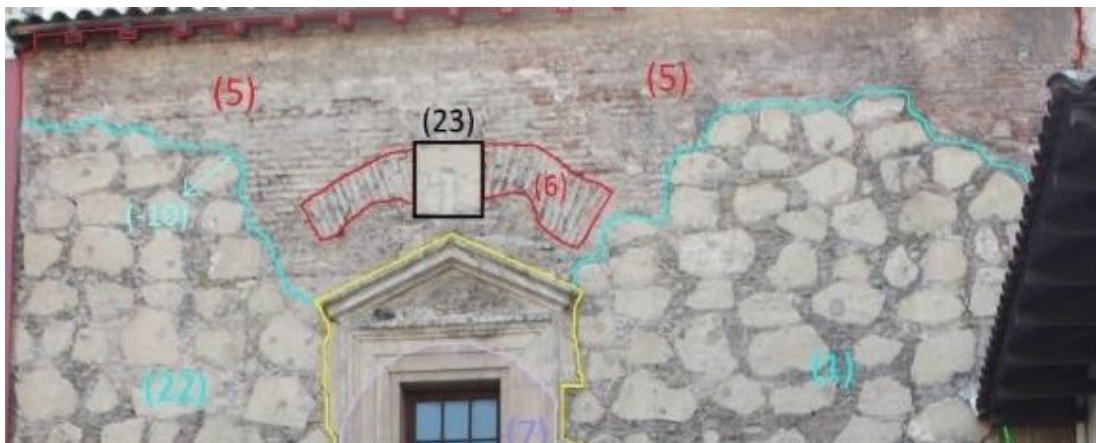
Detalle en fachada de elemento interfacial de posible derrumbe (UE 10) que alteró al muro de mampostería (UE 1) y su posterior reparación en albañilería en ladrillo (UE 5).
